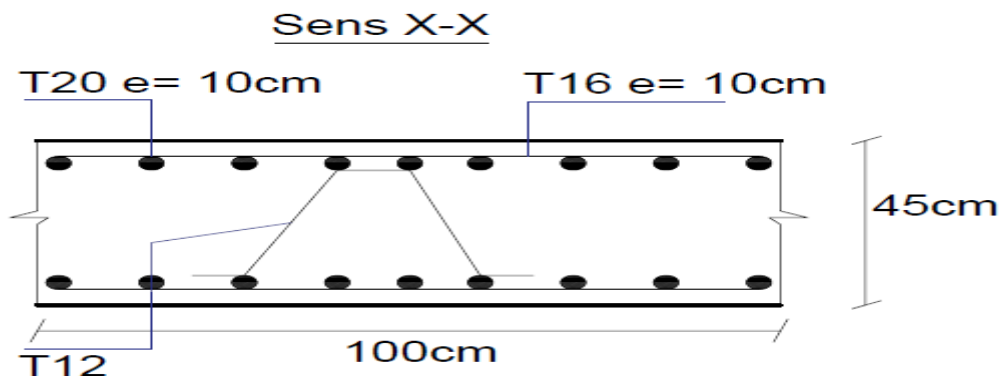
Schéma de ferrailage de la dalle du radier sens x-x.
